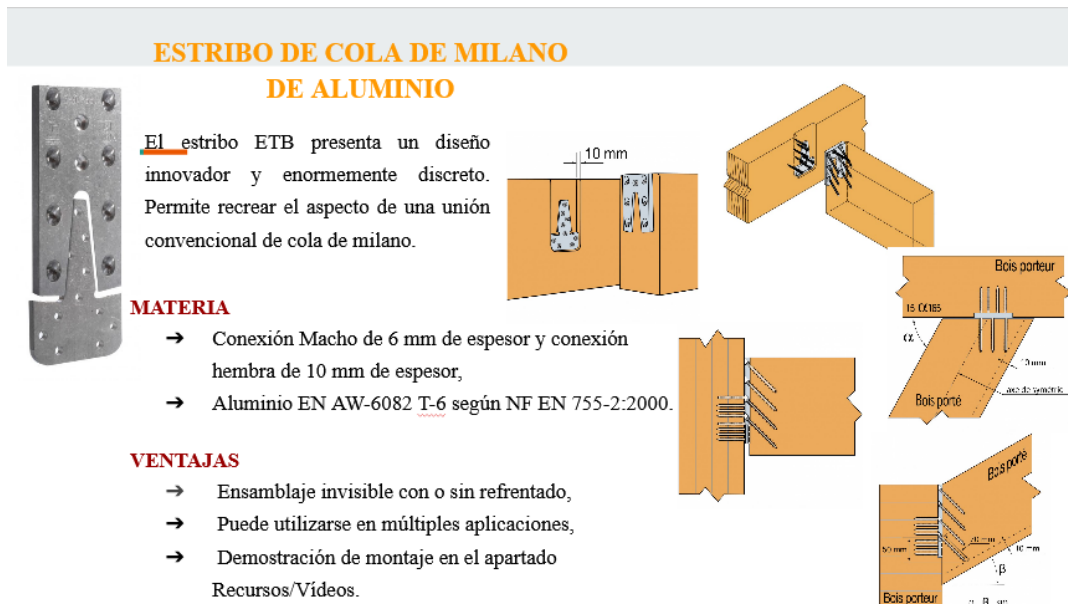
Estribo de cola de milano de aluminio Adaptado de. SIMPSON StrongTie, Estribo de cola de milano-Aluminio Recuperado de. <https://www.conectore.com/products/detail/estribo-de-cola-de-milano-de-aluminio/60>
